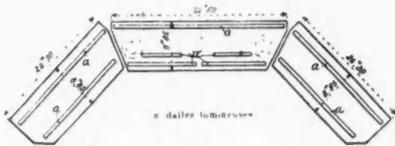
PLAN SCHEMATIQUE DES TROIS PONTONS
